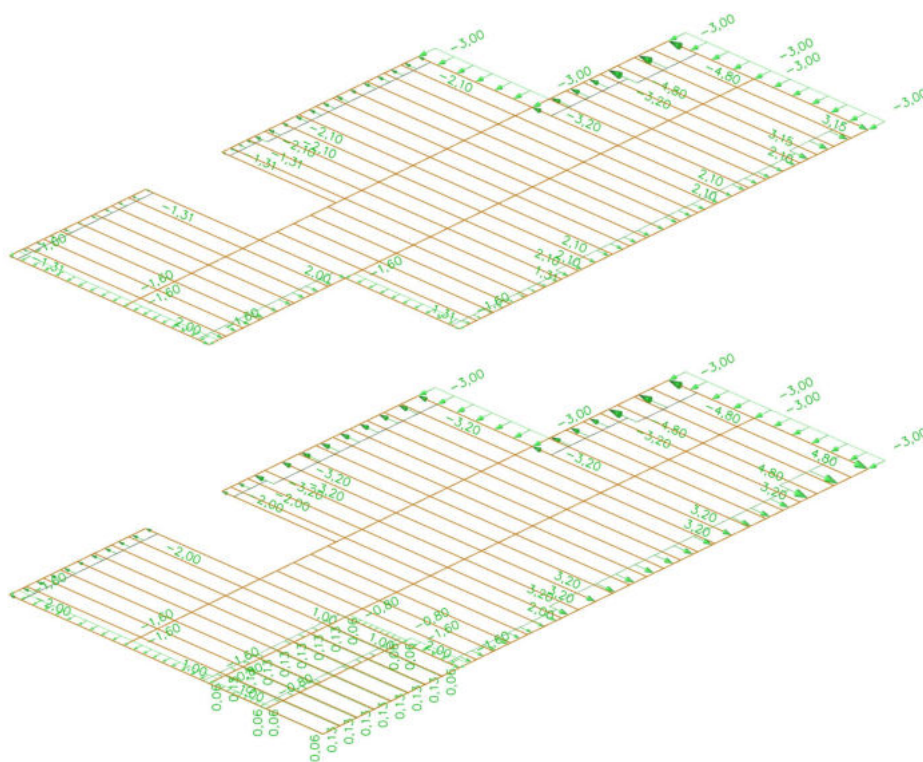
Zatížení stropní konstrukce příčným větrem zprava 1:2
